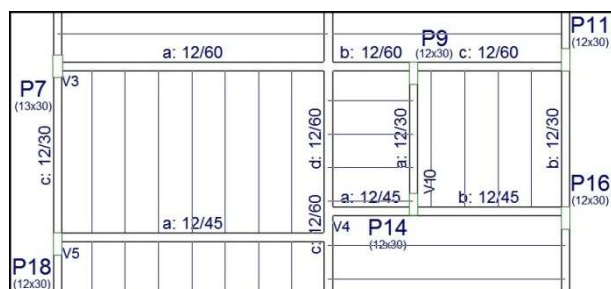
Vigas rearmadas corretamente. Fonte: Os autores, 2019.
